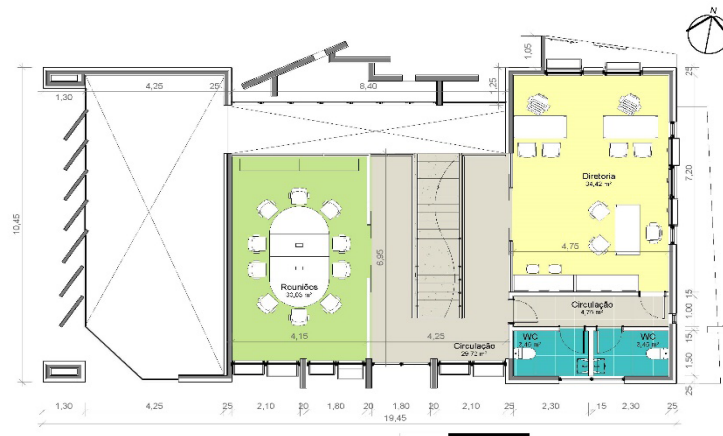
Planta baixa do pavimento superior, circulações com pé direito duplo.
